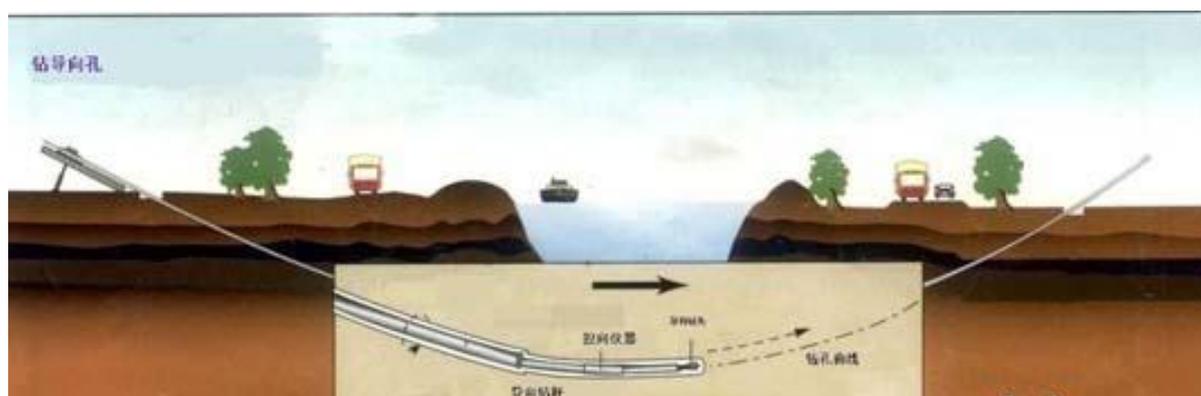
定向钻穿越施工钻导向孔过程断面示意图
